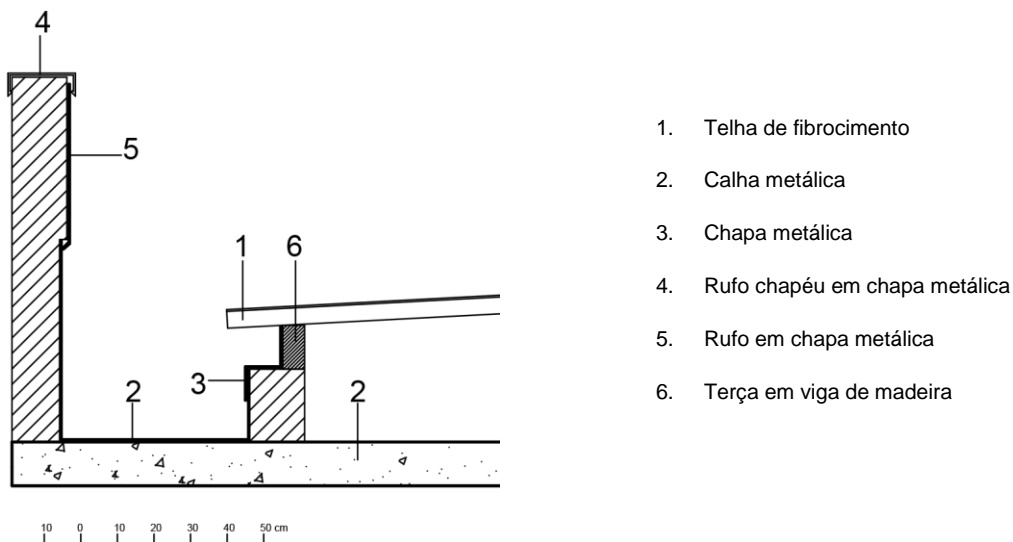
Detalhe da calha em chapa metálica existente (Fonte: SEF)
